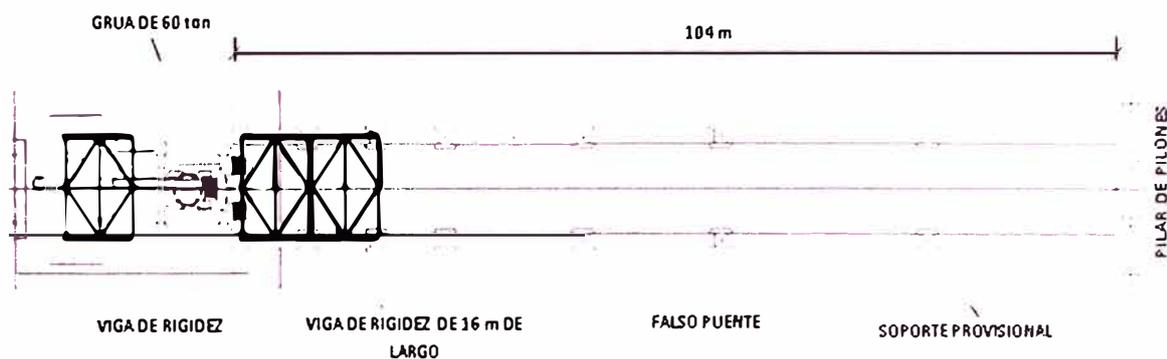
VISTA DE PLANTA TRASLADO DEL PRIMER TRAMO VIGA DE RIGIDEZ
